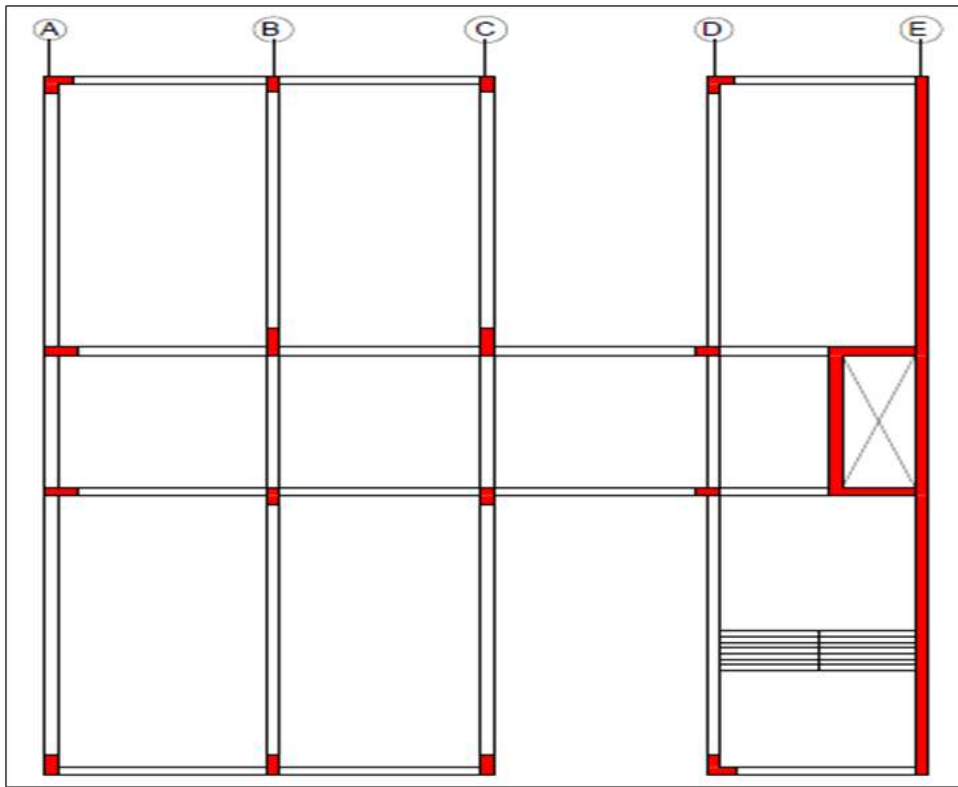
Vista en planta del edificio con mucha rigidez en un extremo y con reducción de losa en planta
